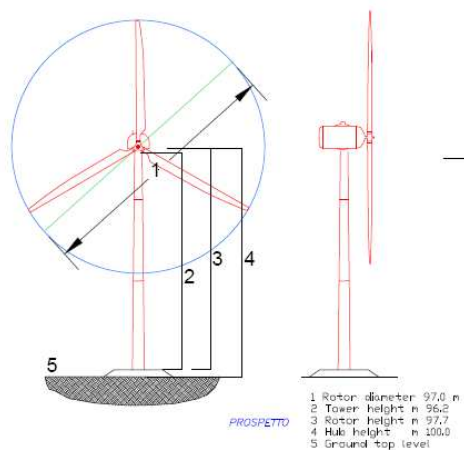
Prospetto e sezione dell'aerogeneratore
